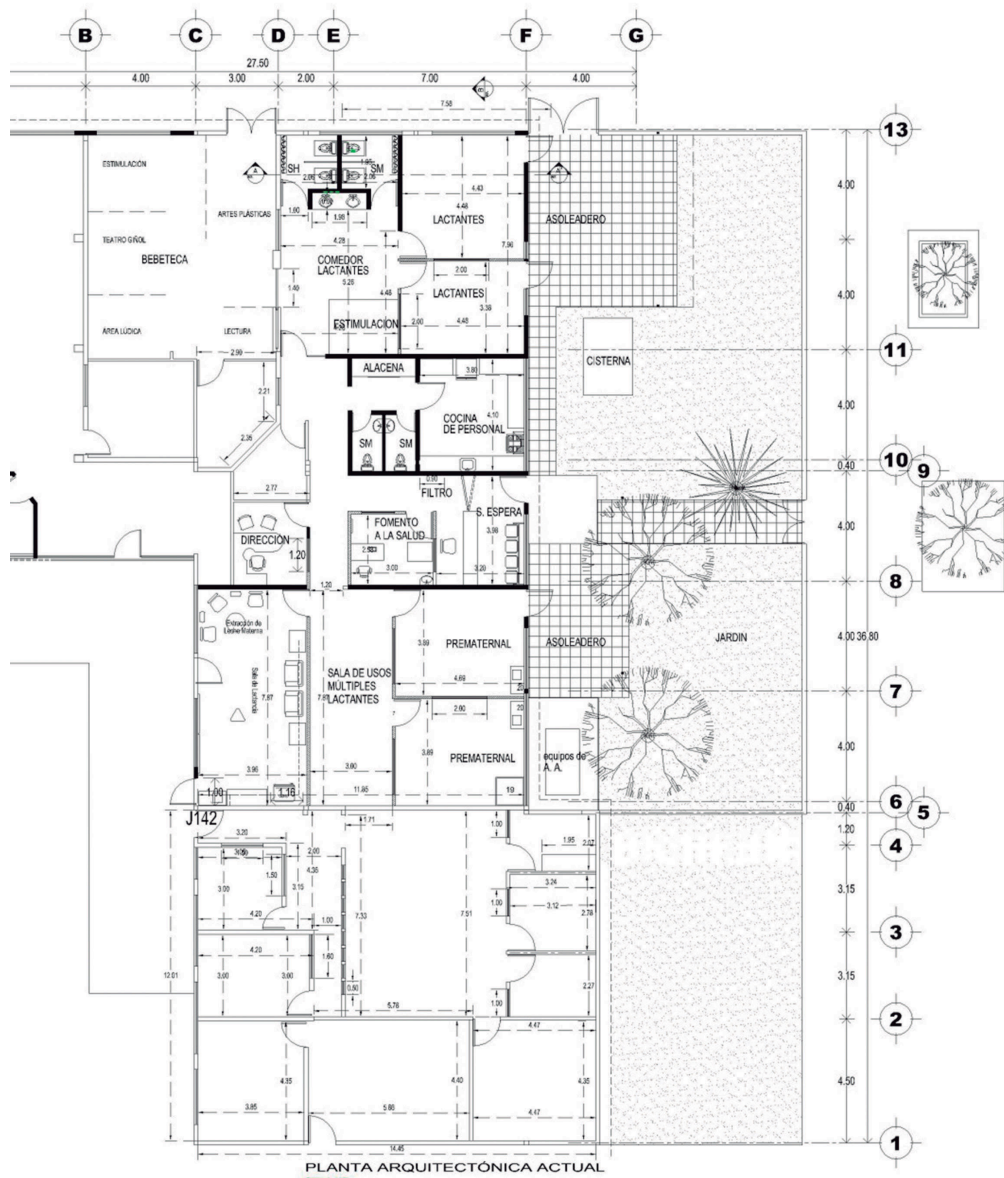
Plano arquitectónico de estancia Baby Delfin
